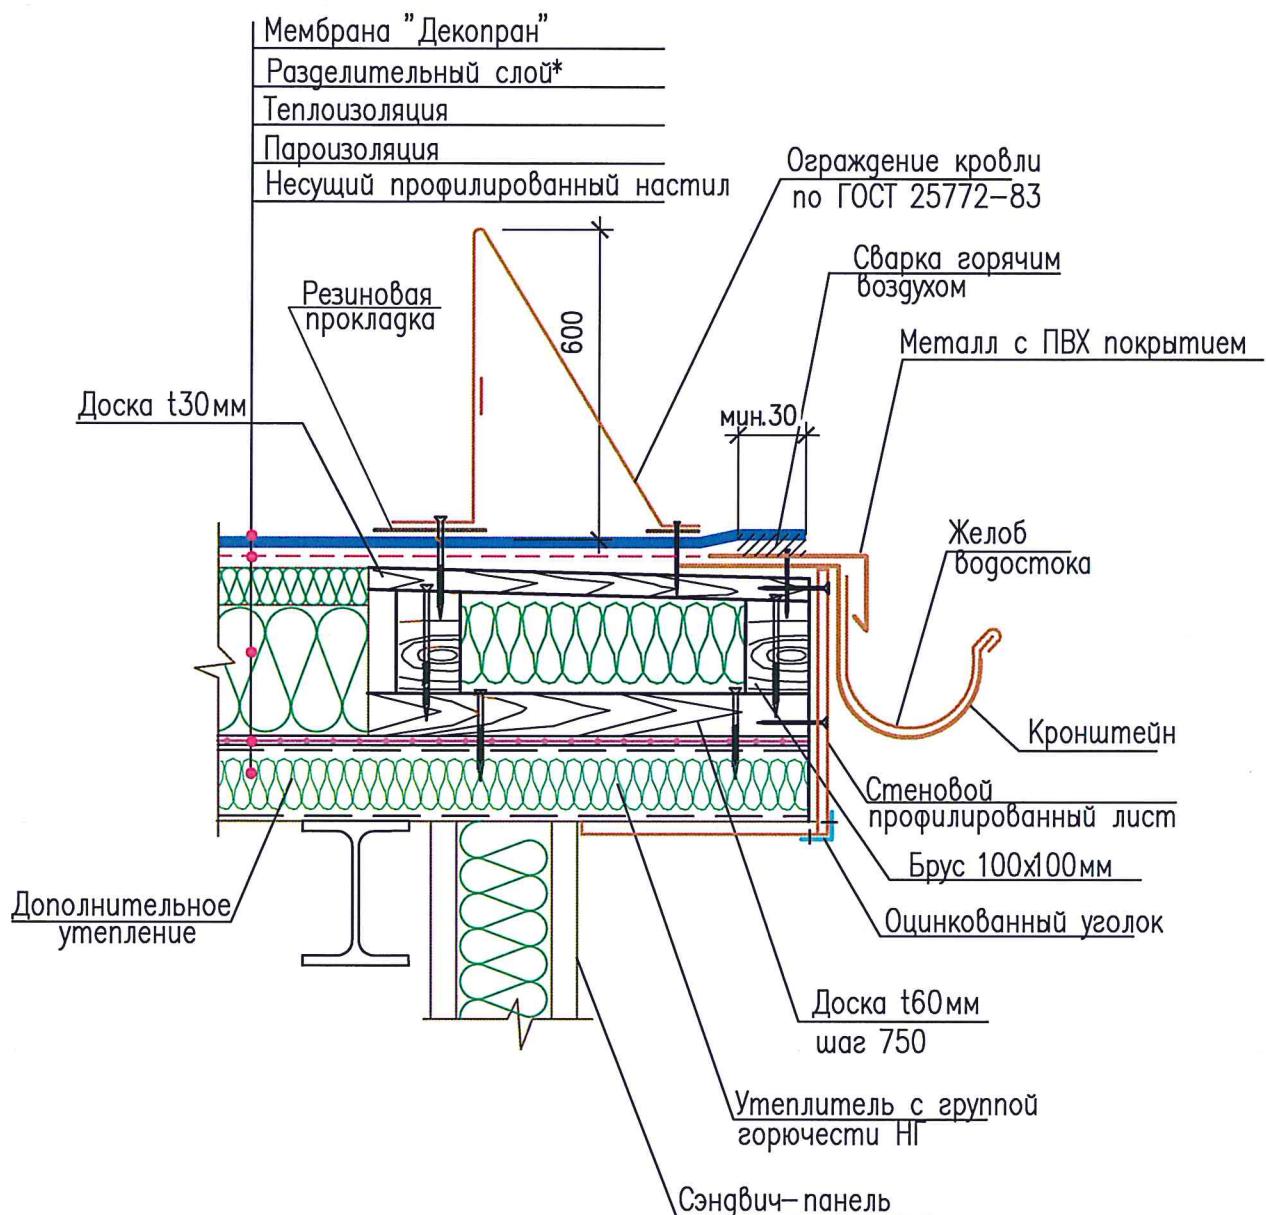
Конструктивные решения узлов для кровли с несущим профилированным настилом с механическим закреплением. Устройство примыкания к продольному парапету
